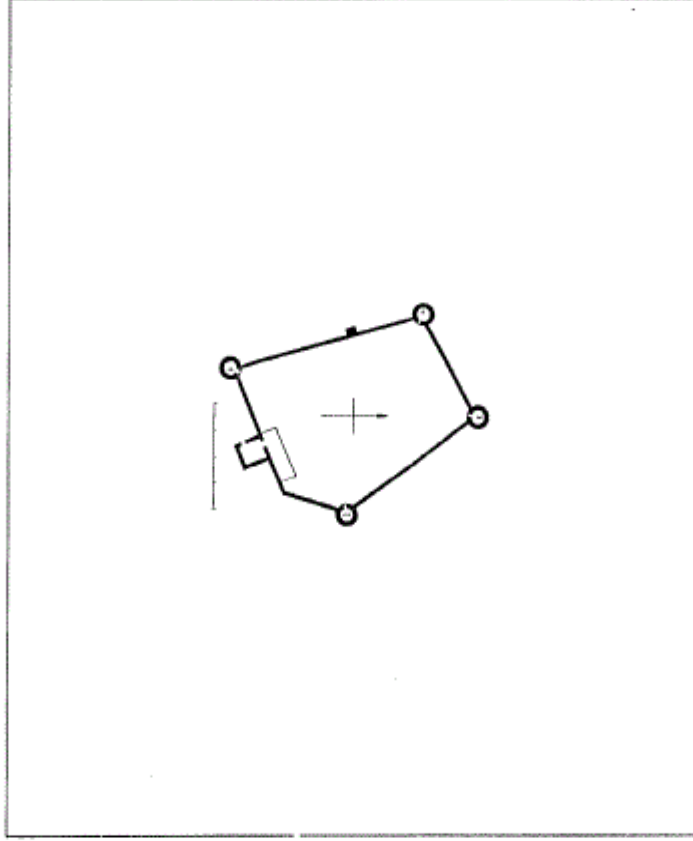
مسقط أفقي لأحد الأبراج في قلعة الأبراج السبعة بإستانبول (عن :
